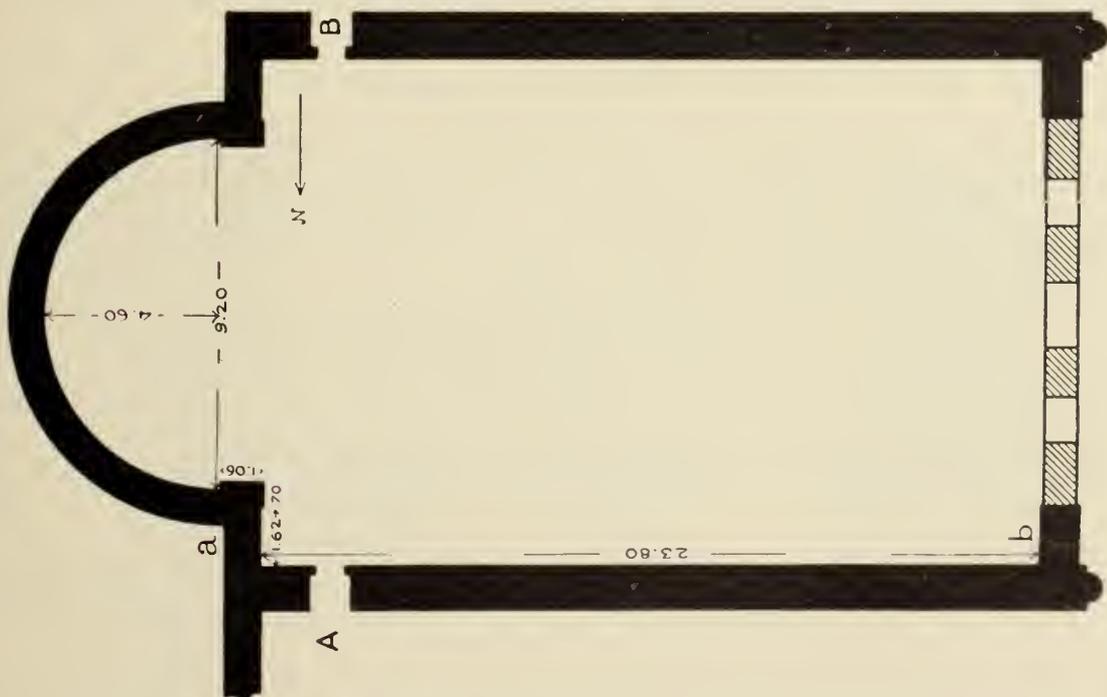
Bosrâ Dêr Bahîrâ: Grundriß.
